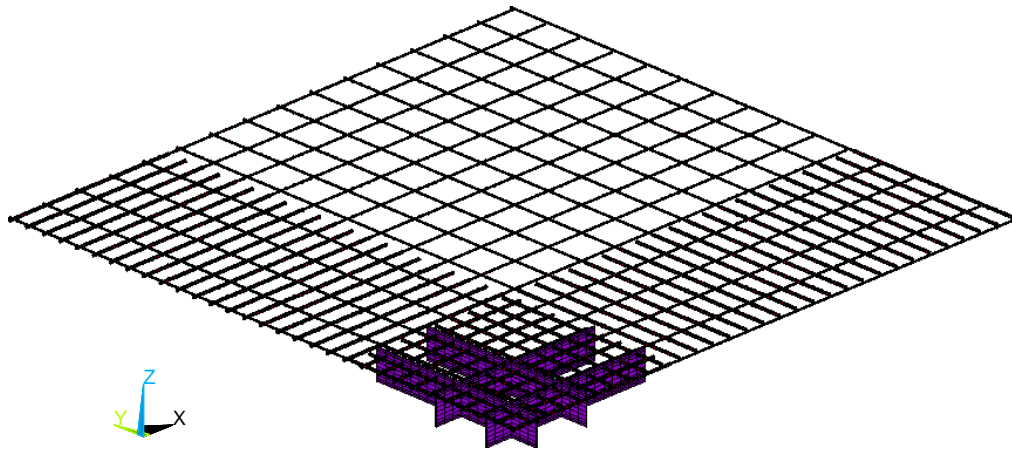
Расчётная схема 81 (РС81). Капитель и верхняя арматура
